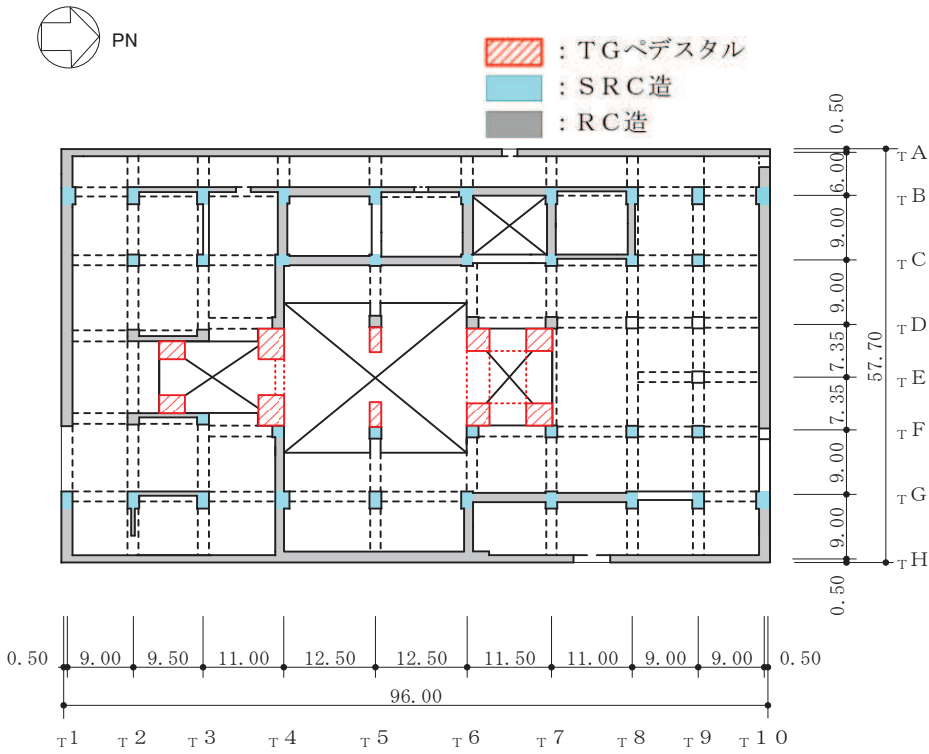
(1) タービン建屋の概略平面図 (0.P. * 0.8m)
